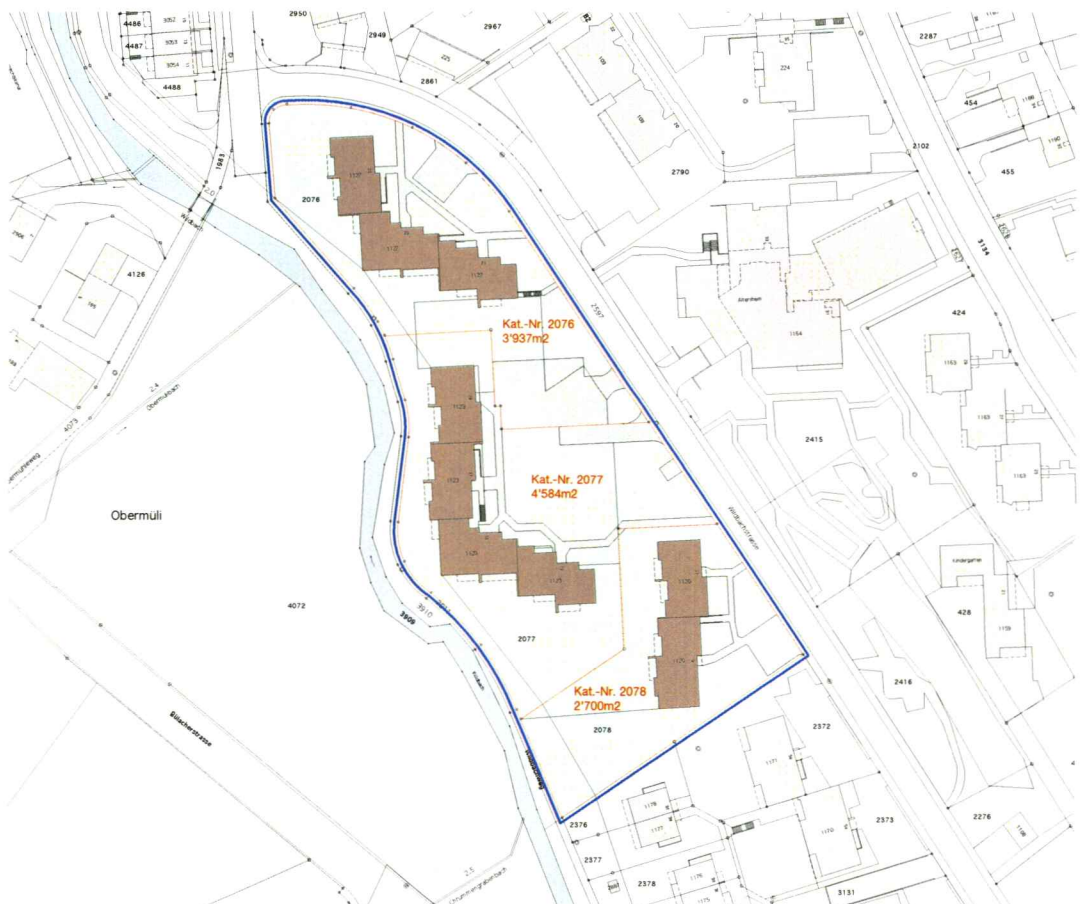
Geltungsbereich Gestaltungsplan Wildbachstrasse (blaue Linie)
